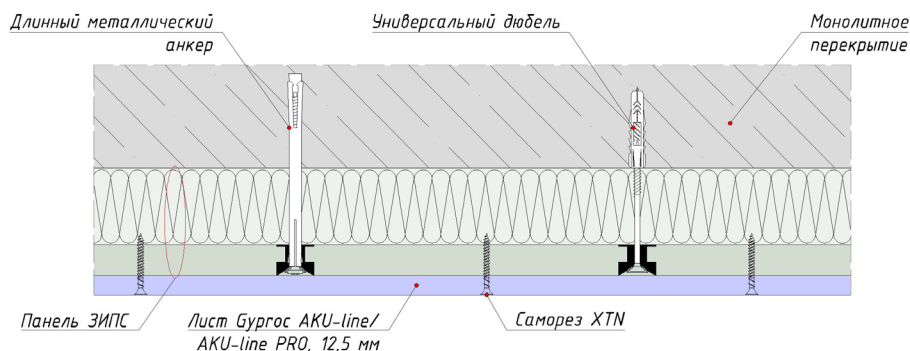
Монтаж панельной системы ЗИПС на монолитное перекрытие.
